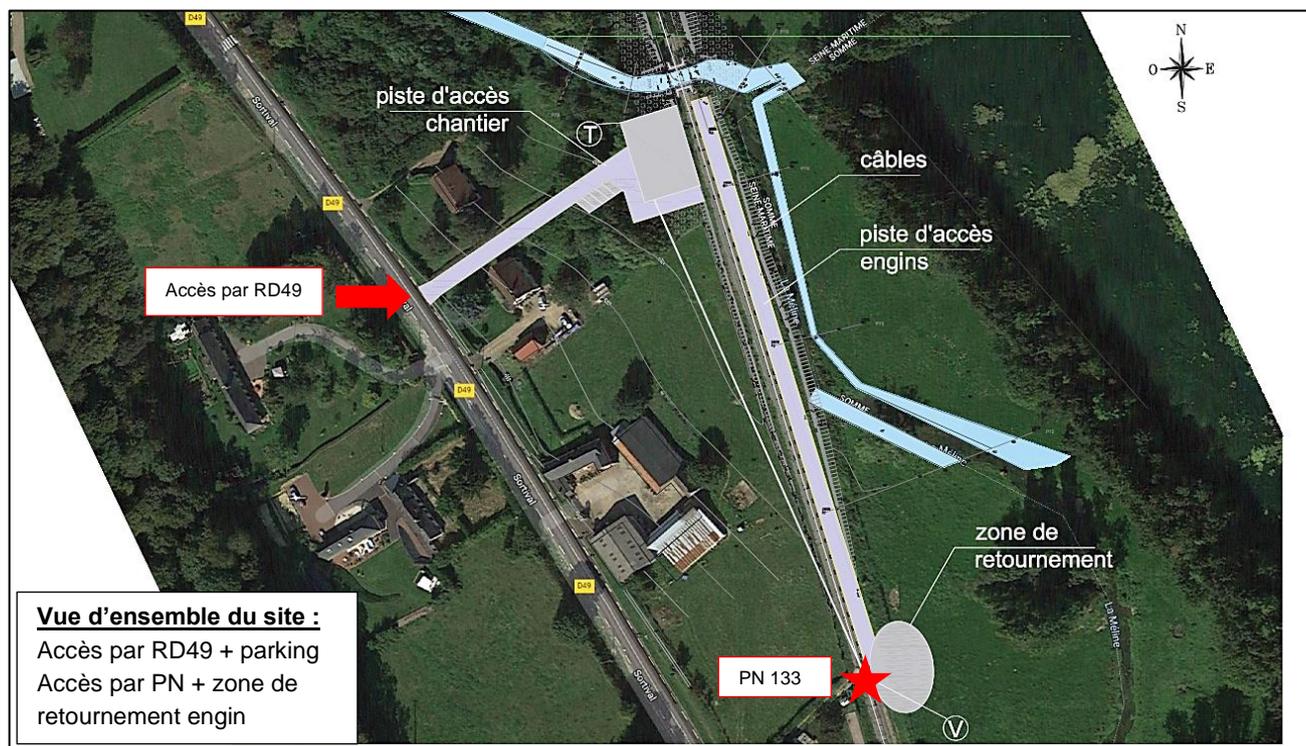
Ligne 325 000 – Vue d'ensemble du site de la base vie
